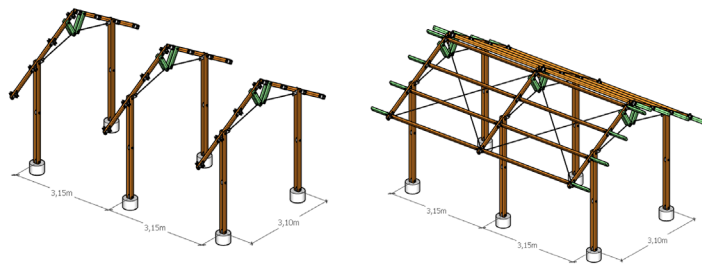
Komponen struktural konstruksi desain Huntara
